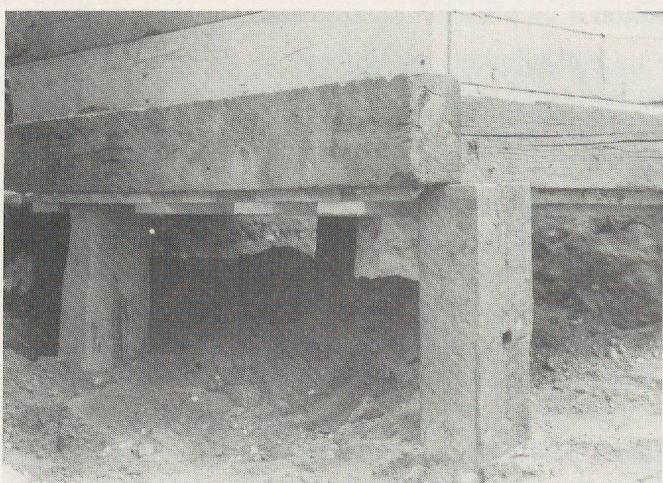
Corseaux «en-Seyton». Creusement en sape sous le coffre et pose d'un fond solidaire du cadre de transport.
